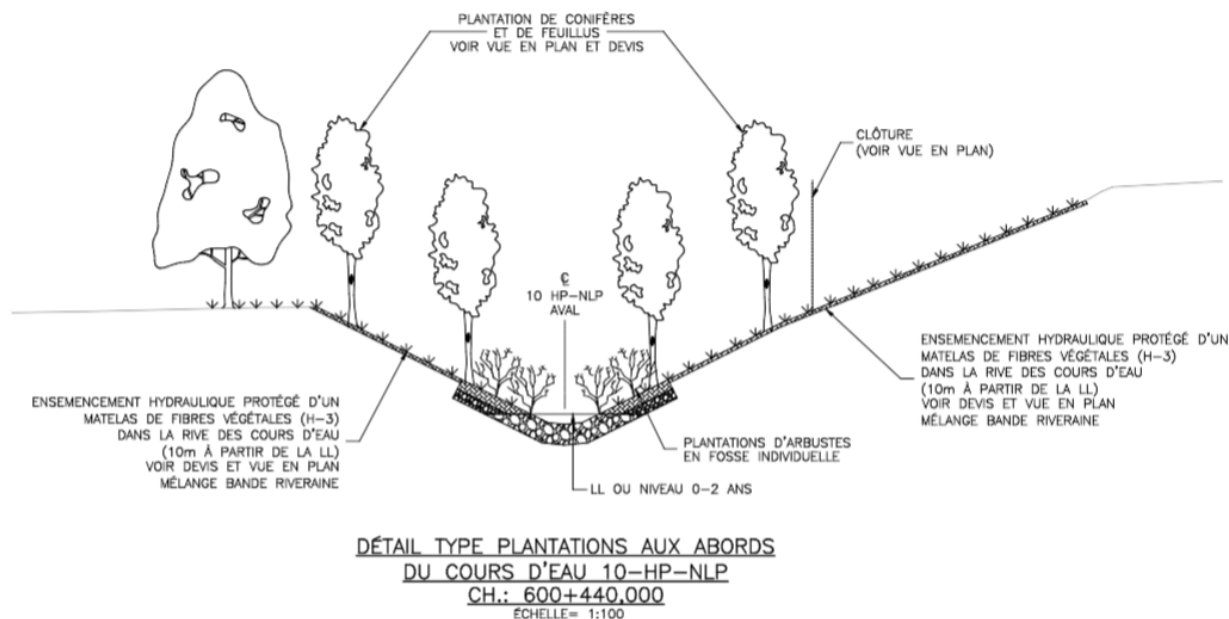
Extrait des plans TP : plantations aux abords du cours d'eau 10-NHP-NLP
